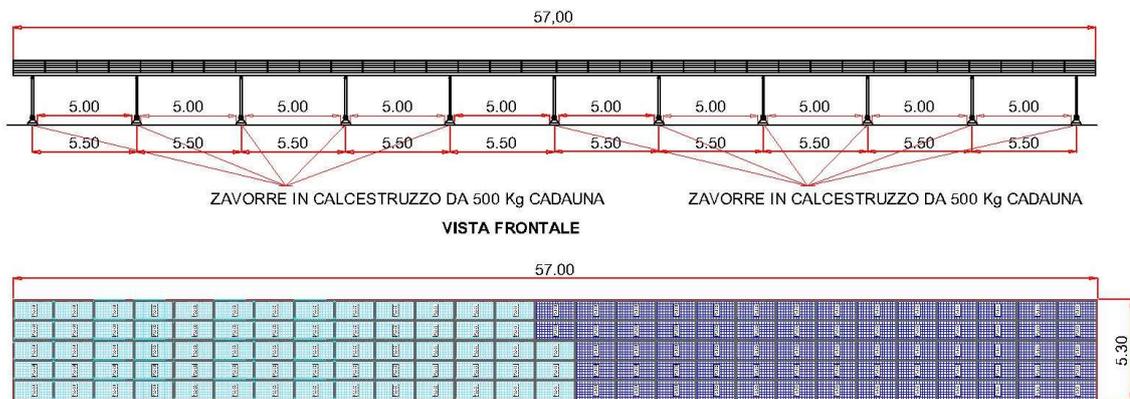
Layout pannelli fotovoltaici pensilina parcheggio P2
